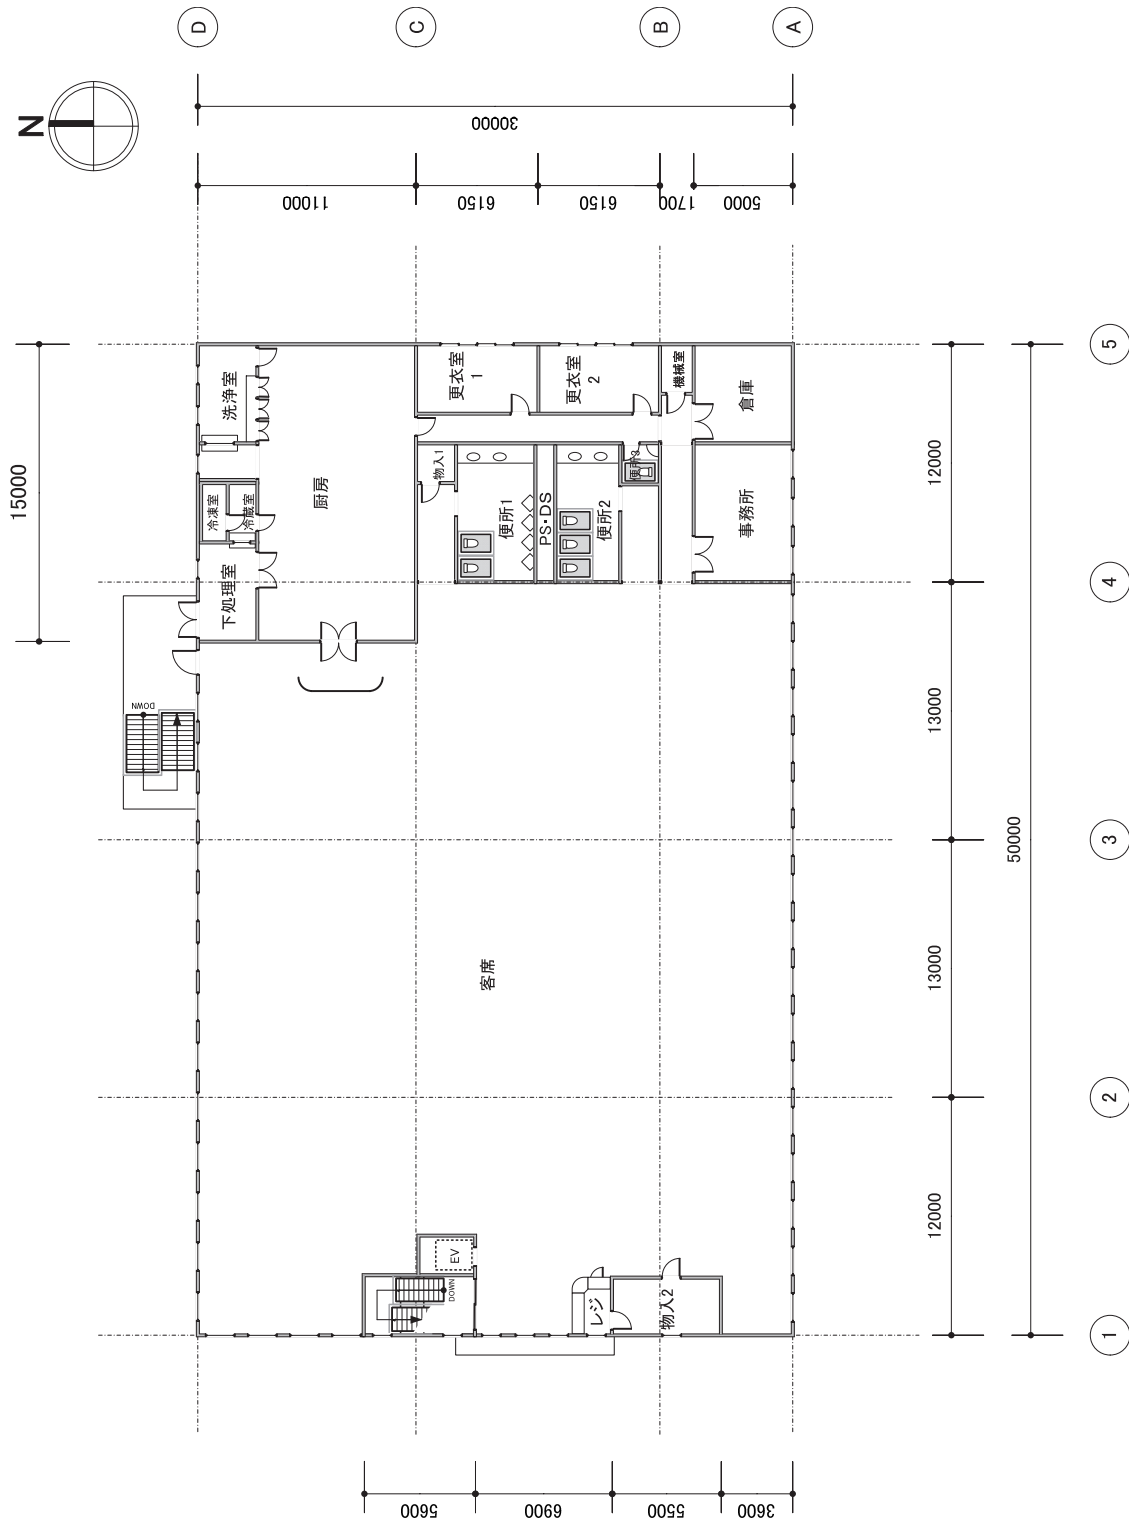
モデル建物 (飲食店等、1,500m²) 2階平面図
